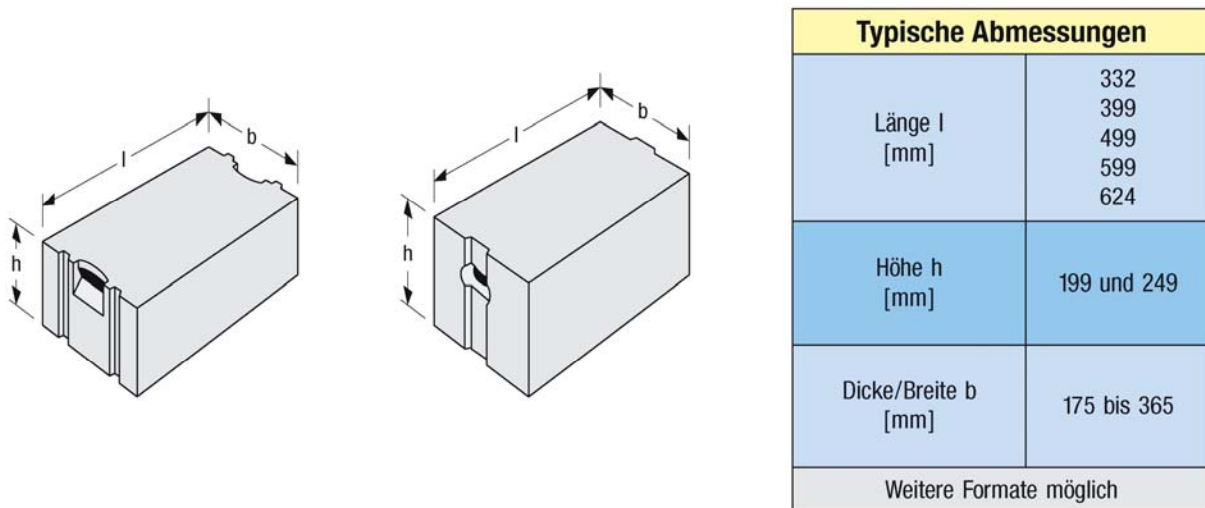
Typische Abmessungen für Porenbeton Plansteine
